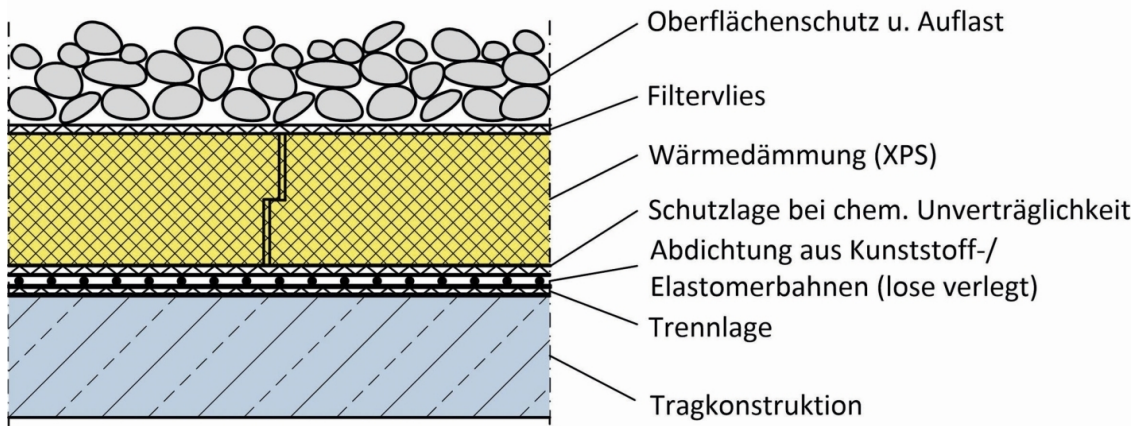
Umkehrdach auf Stahlbetondecke (Quelle: Schmidt)
